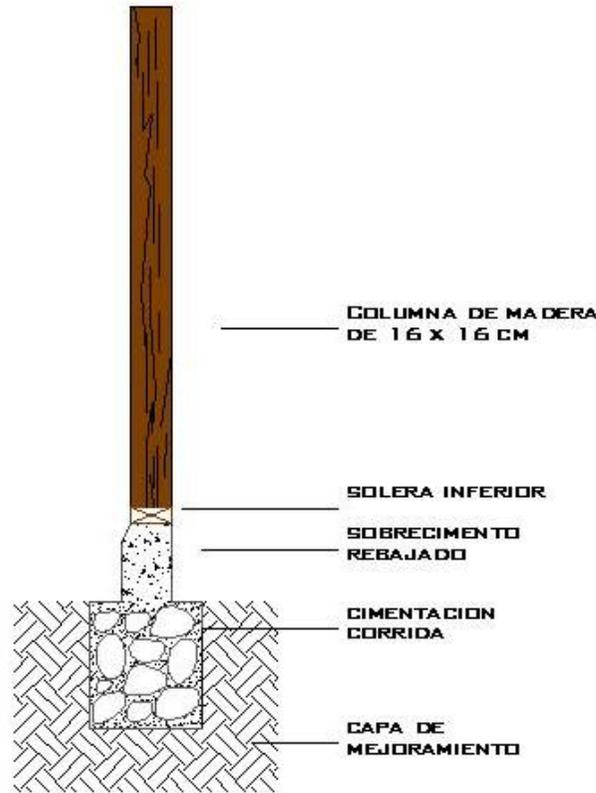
COLUMNA CON SOBRECIMIENTO REBAJADO
